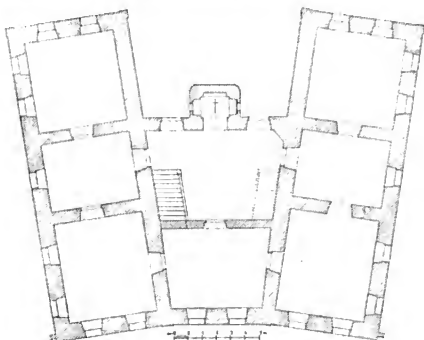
Režihlavy. Grundriss des Schlosses.
